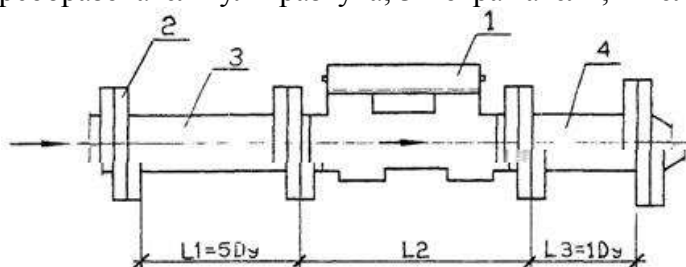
Схема монтажа: 1 - ультразвуковой счетчик; 2 - фланец; 3, 4 – патрубок.
